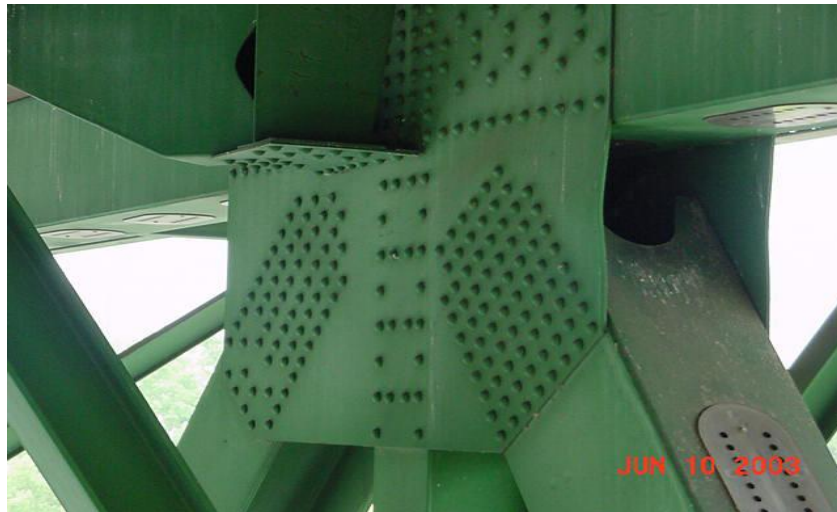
Chapa de Gusset da Ponte I-35 W.
